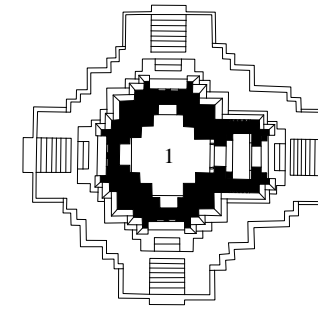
Plan du Mangalârtha dans Angkor Thom
